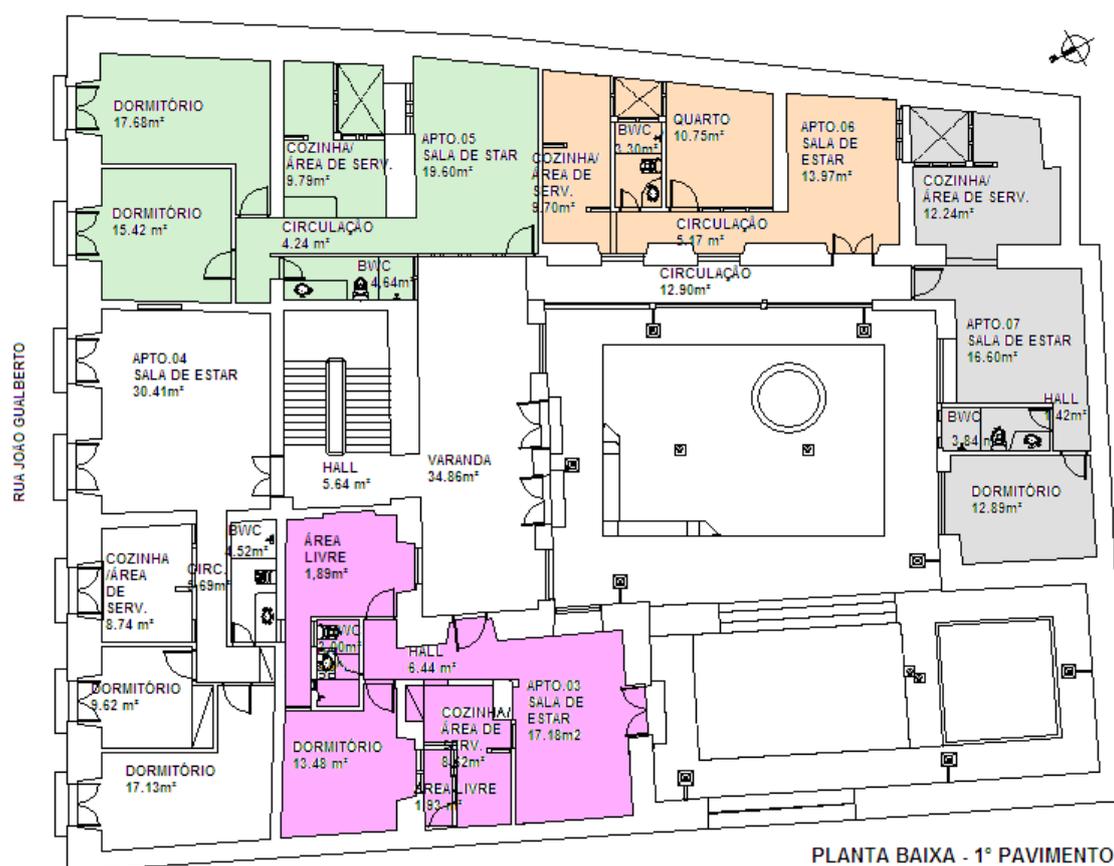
Ilustração de Planta Baixa de Primeiro Pavimento
